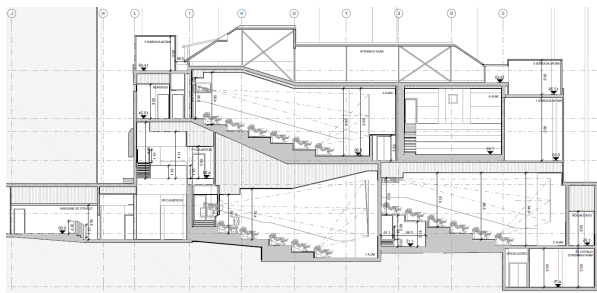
Alzado Longitudinal estado reformado, Cine Palafox
